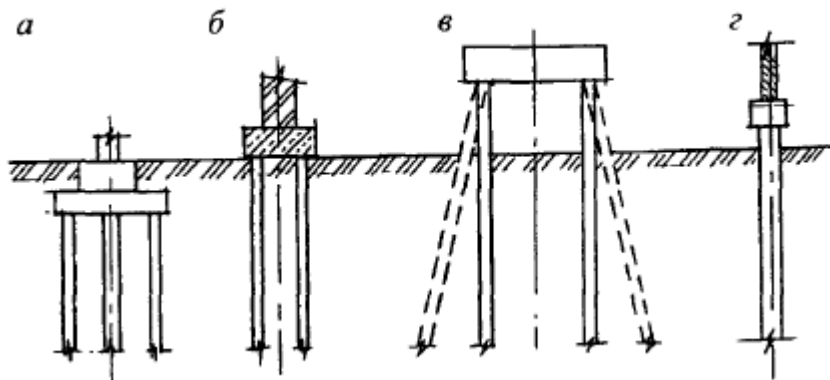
Типы свайных ростверков: а – низкий; б – повышенный; в, г – высокий
